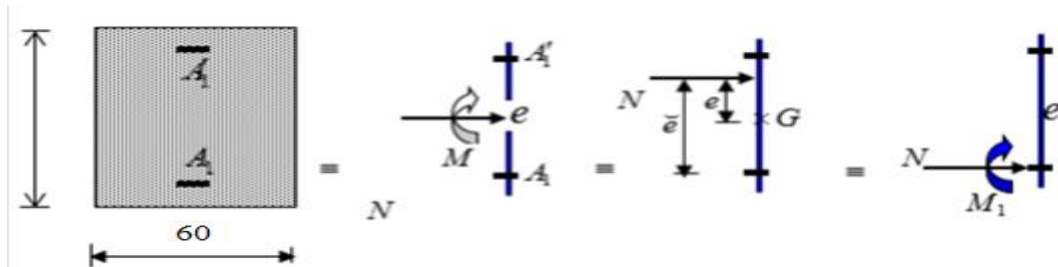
Position de N_1 , M_1 et M'_1 sur la section transversale.
